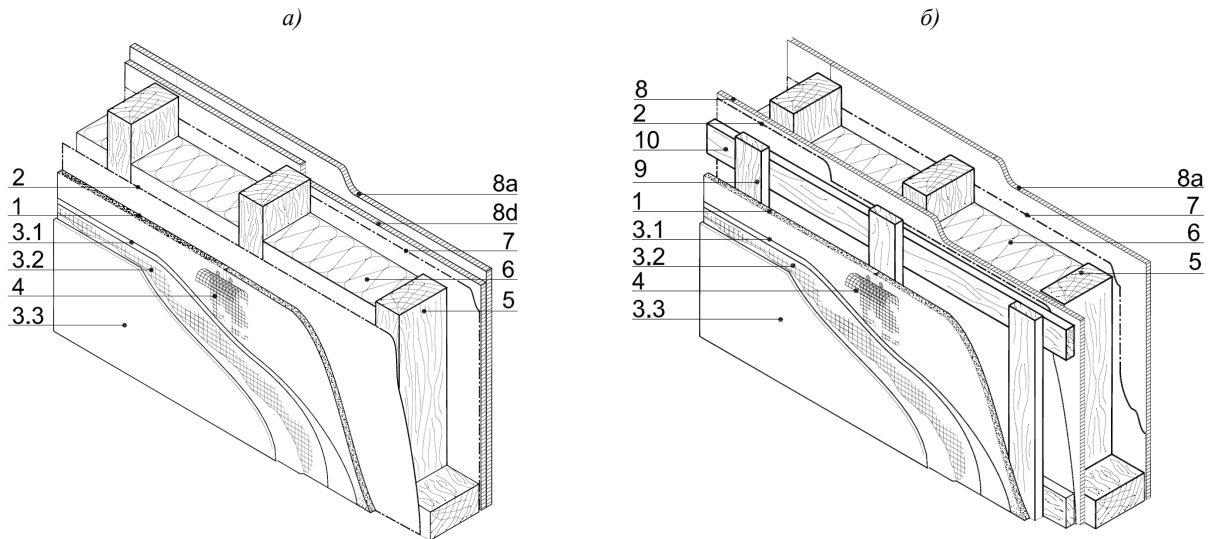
Несущая наружная стена на деревянном каркасе: а) с прямым креплением плит к каркасу; б) с креплением плит к деревянной обрешетке, где 1- цементная плита AQUAPANEL Outdoor; 2 - паро-гидробарьер AQUAPANEL TYVEK StuccoWrap; 3.1 - армирующий и клеящий раствор AQUAPANEL; 3.2 - сетка для наружных работ AQUAPANEL; 3.3 - штукатурная накрывка AQUAPANEL; 4 - шпателька для швов AQUAPANEL - серая и лента для швов AQUAPANEL; 5 - несущий профиль; 6 - изоляционный материал (KnaufInsulation или Heraklith); 7 - пароизоляционный слой; 8а - гипсокартонная плита КНАУФ; 8d - плита древесностружечная (OSB); 9 - несущая обрешетка; 10 - основная обрешетка
